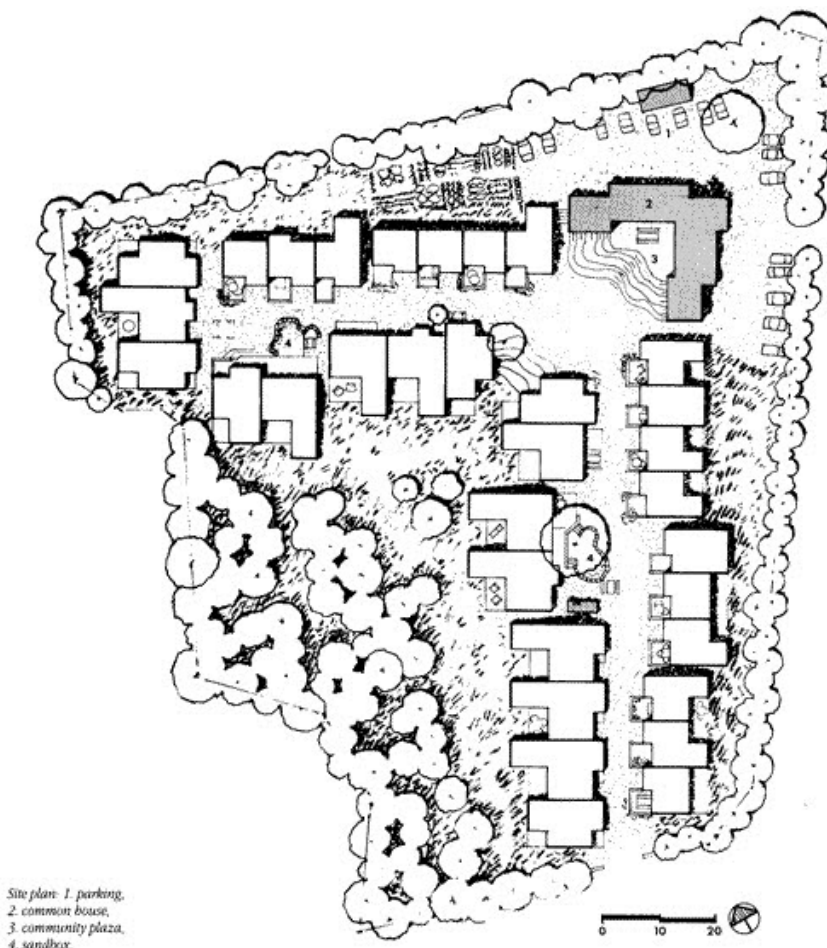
Trudslund. Planta. Fuente: (Mccamant, & Durrett 1994)
